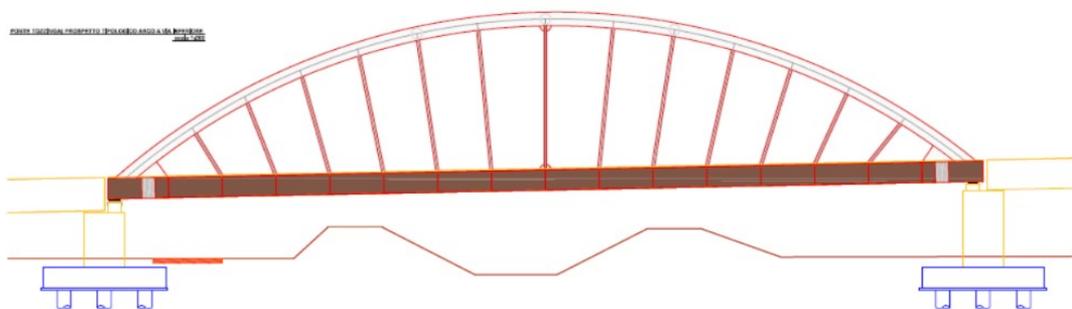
Prospetto tipologico ponte ad arco a via inferiore su Tozzinga
